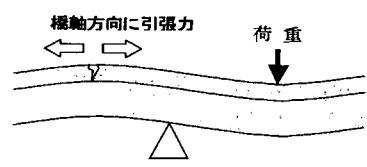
場所打ちPC床版コンクリートのひび割れ要因
